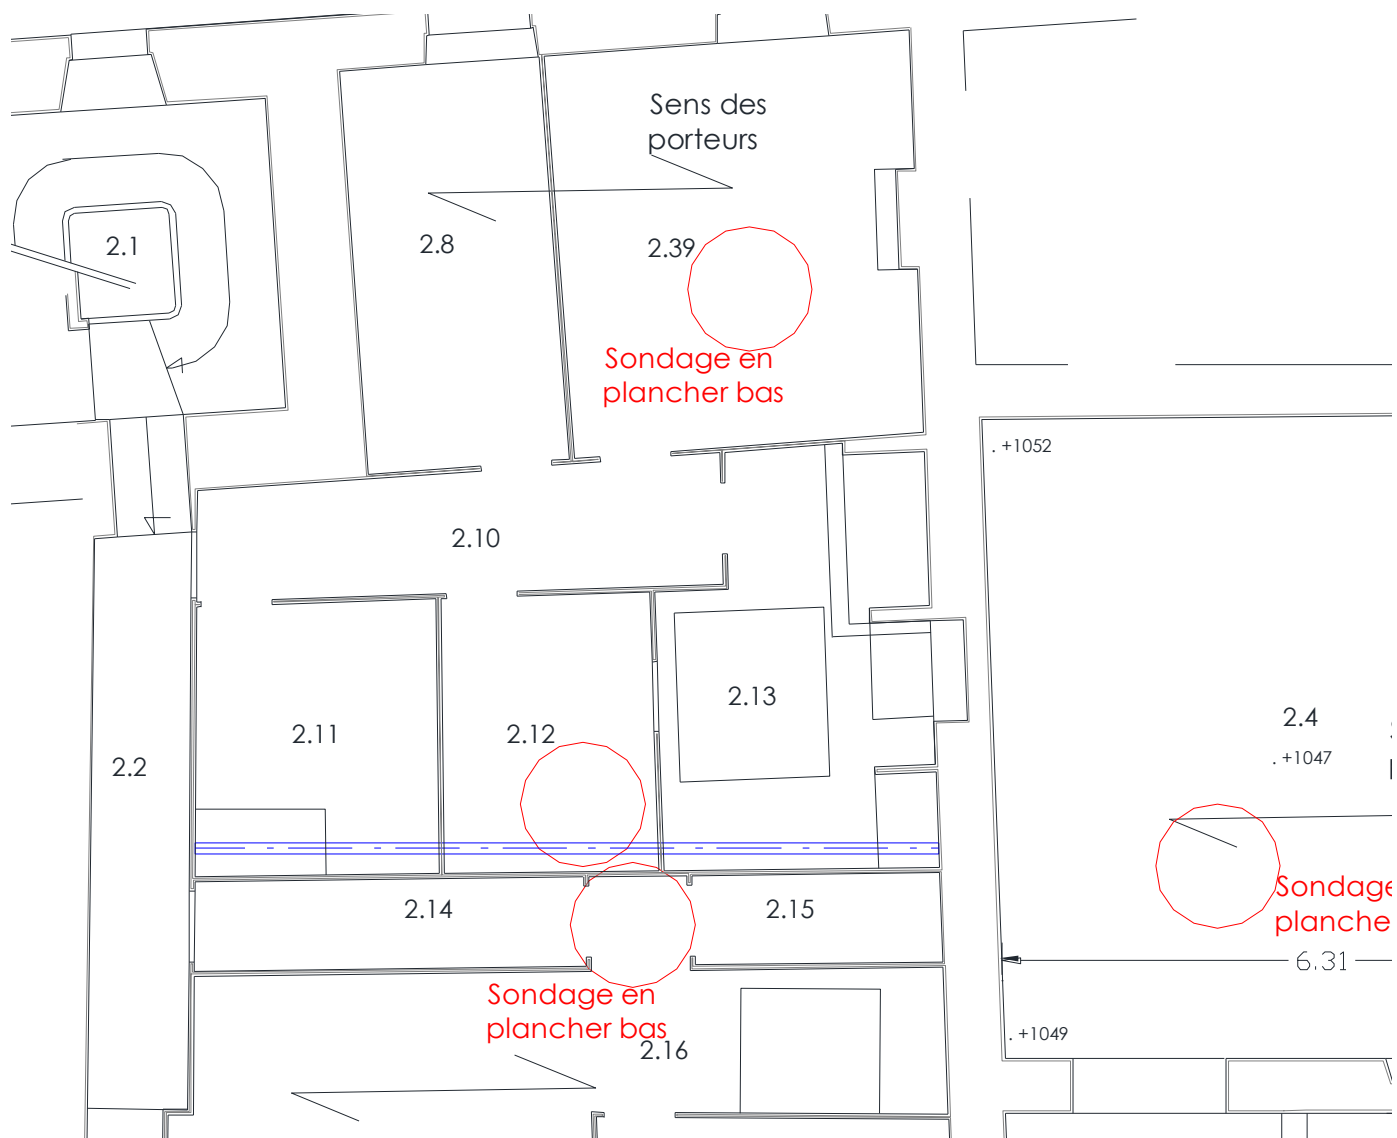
Vue en plan du 2^{ème} étage - Disposition des porteurs
